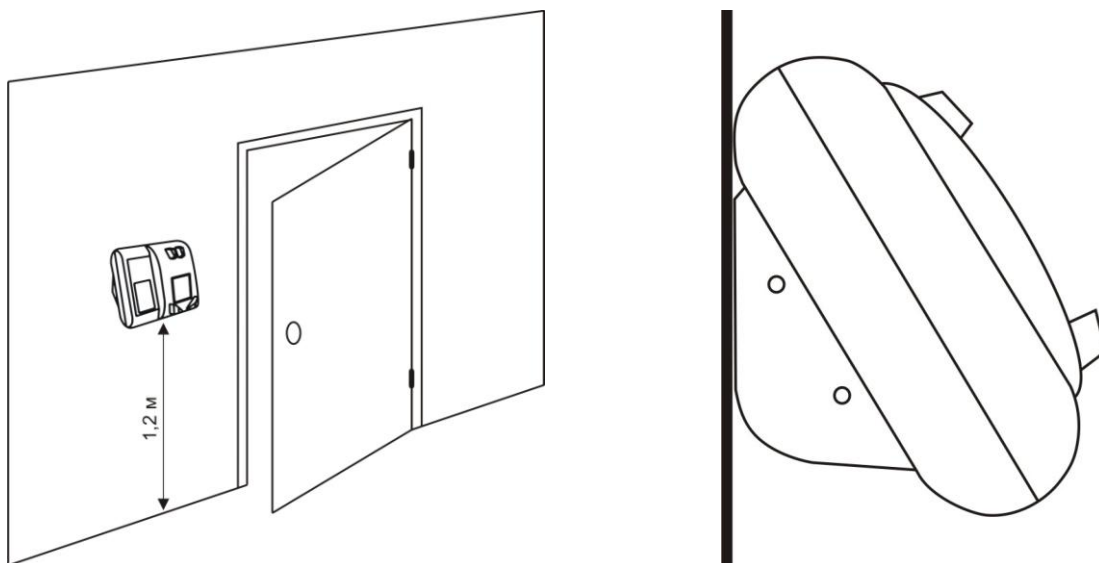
Расположение блока терминала Elsys-PVR-TA при установке на вертикальную поверхность
